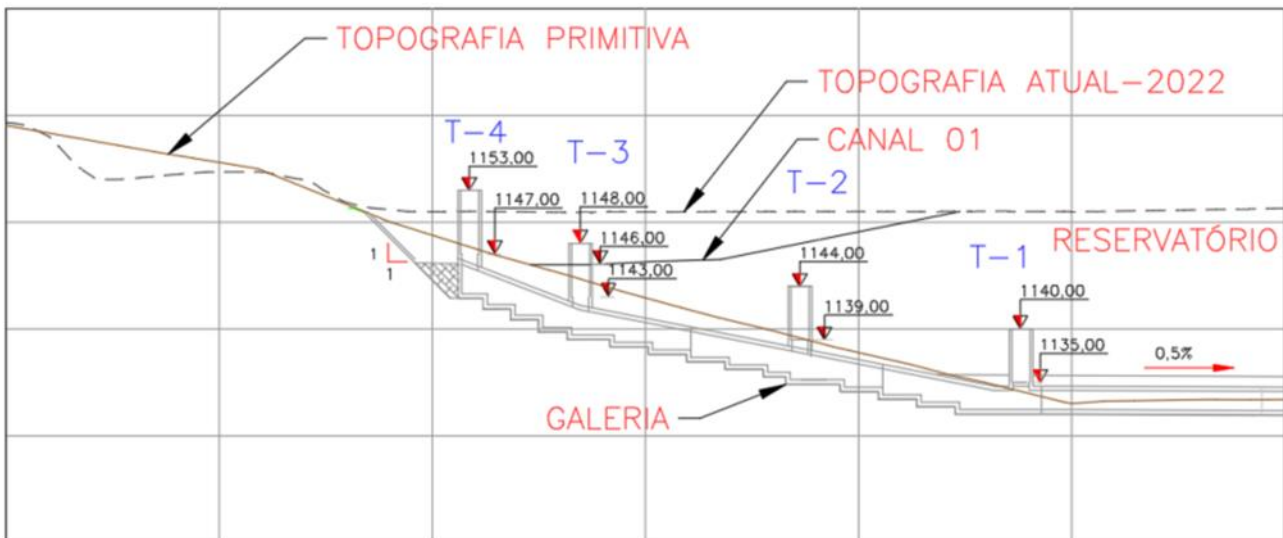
Perfil do projeto de rebaixamento do extravasor, projeto 1850HH-X-39178 (Fonte: KCB, 2023).
